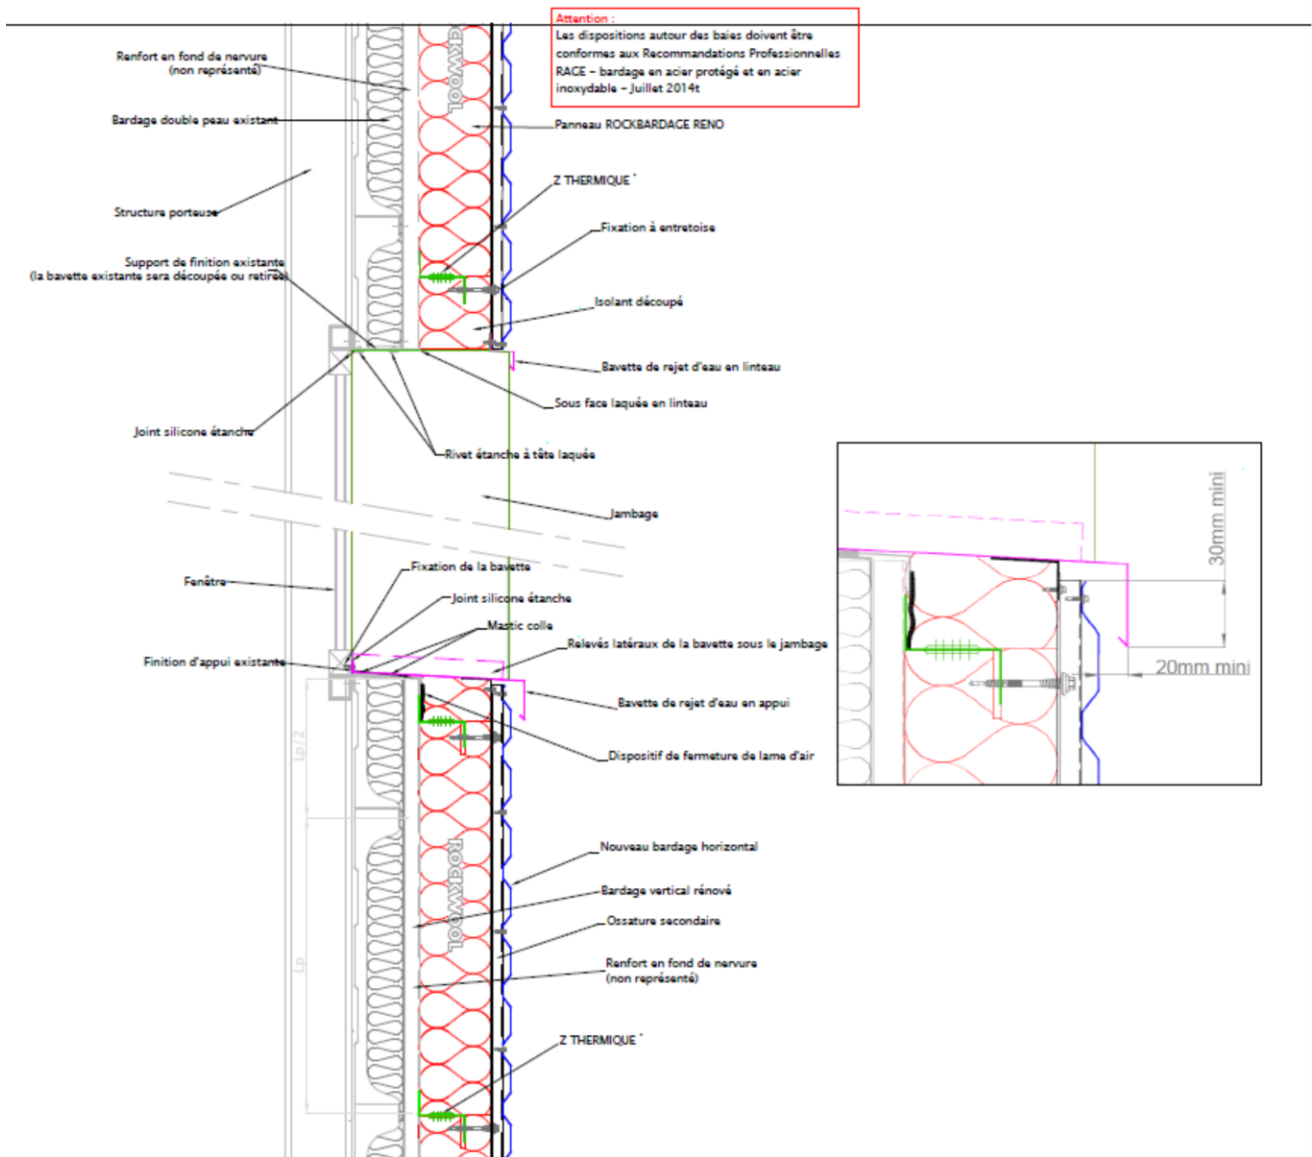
Exemple de traitement de baies, coupe verticale, cas d'une solution avec ossature secondaire
